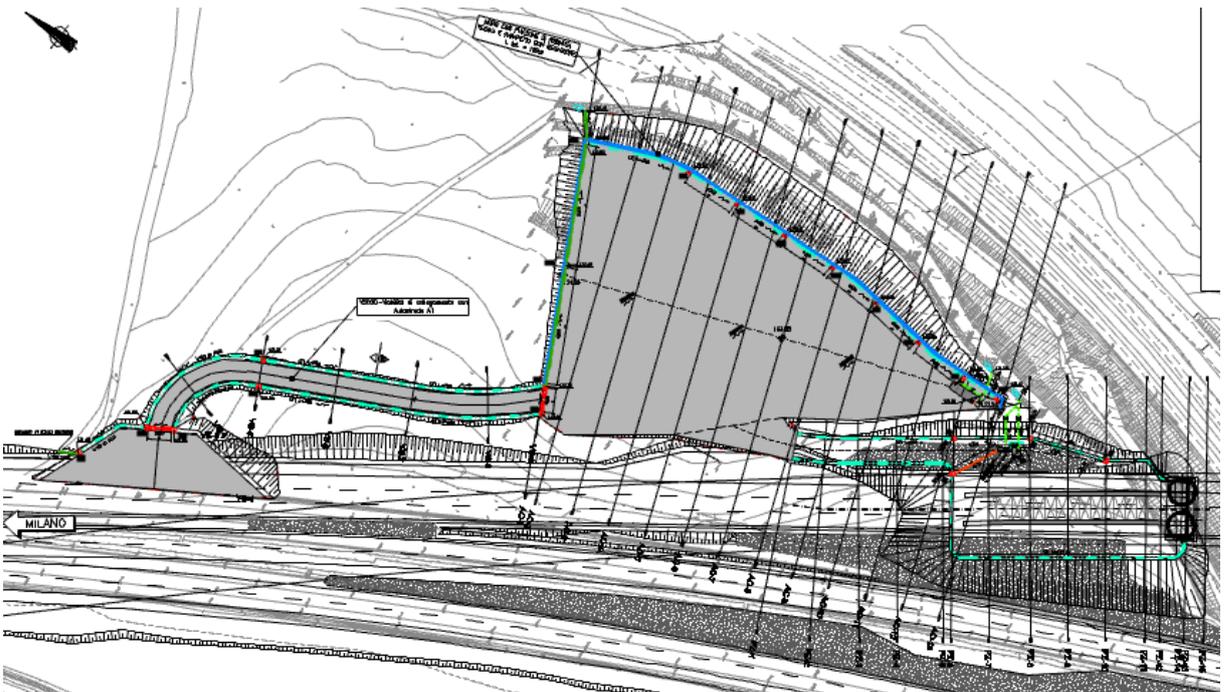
Planimetria reti idrauliche di AC01 – Area supporto progr. km 318+250
